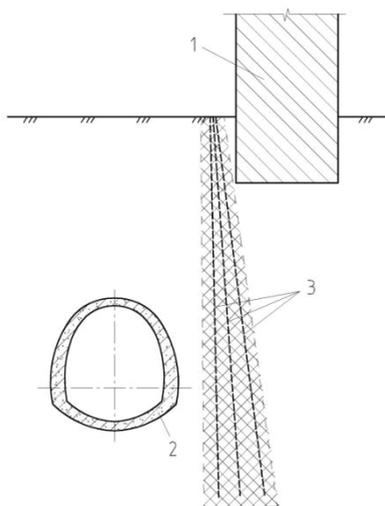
Защитная стенка из пересекающихся грунтоцементных колонн между тоннелем и фундаментом здания в г. Милан, Италия:
